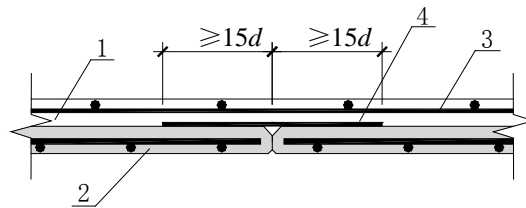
单向叠合板侧分离式拼缝构造示意
